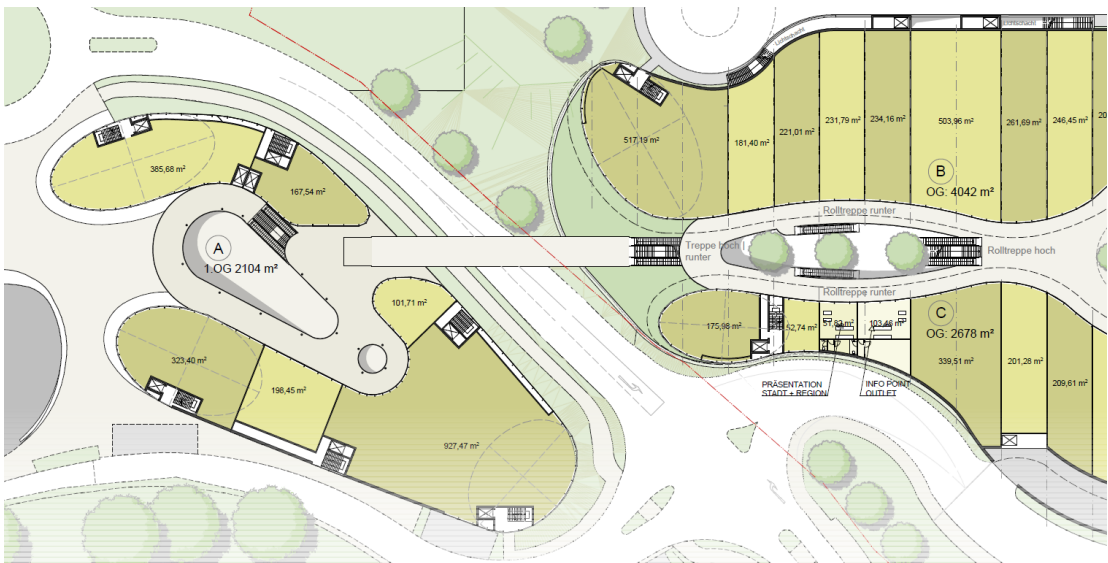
Visualisierungen und Grundriss (Vorabzug) der geplanten Erweiterung des Montabaur The Styles Outlets
